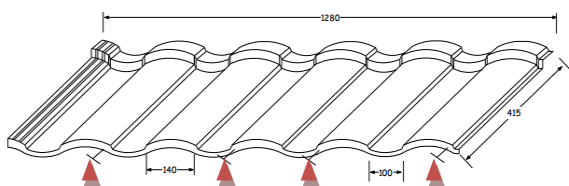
tuile METROTILE® SHAKE - position des fixations
